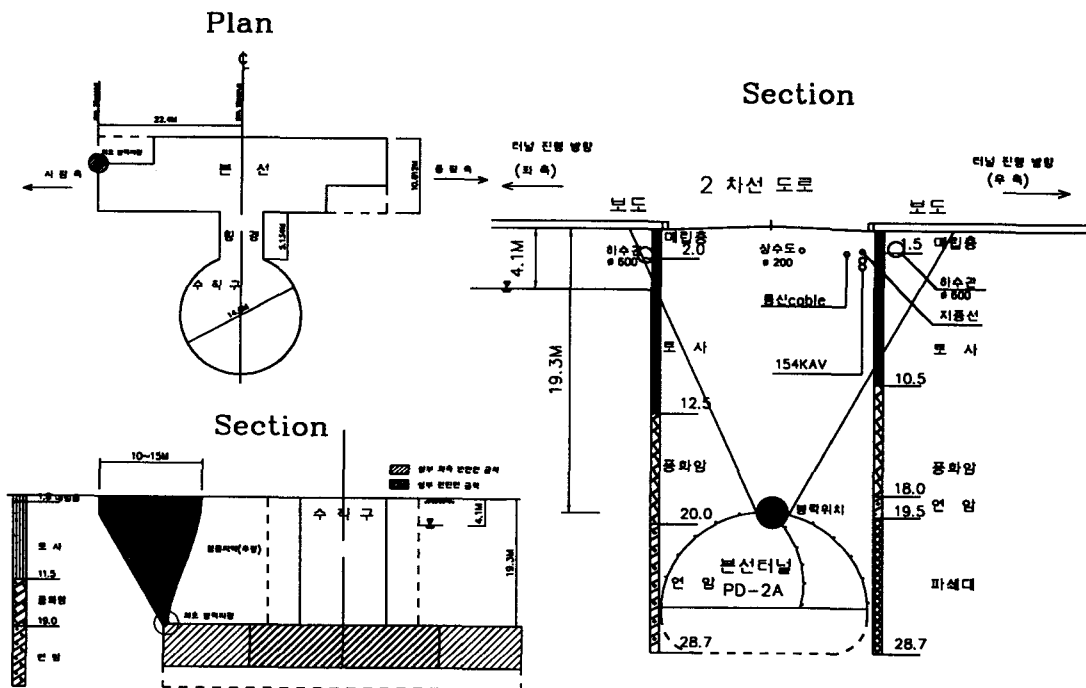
터널 붕괴지점의 평면도 및 중·횡단면도
